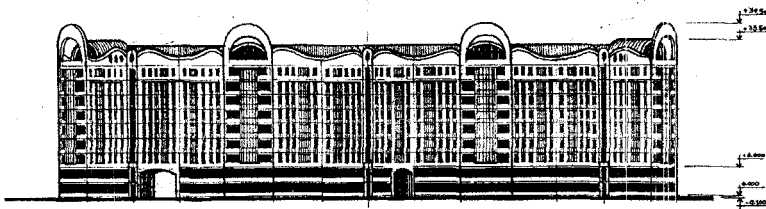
Фасад здания архитектурно-строительной системы "МЕКАР"
